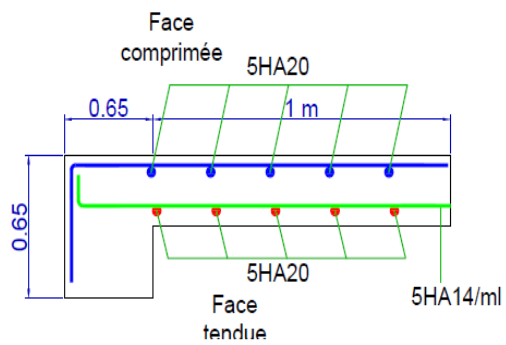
Schéma de ferrailage (Section transversale) du sens secondaire Du voile périphérique
